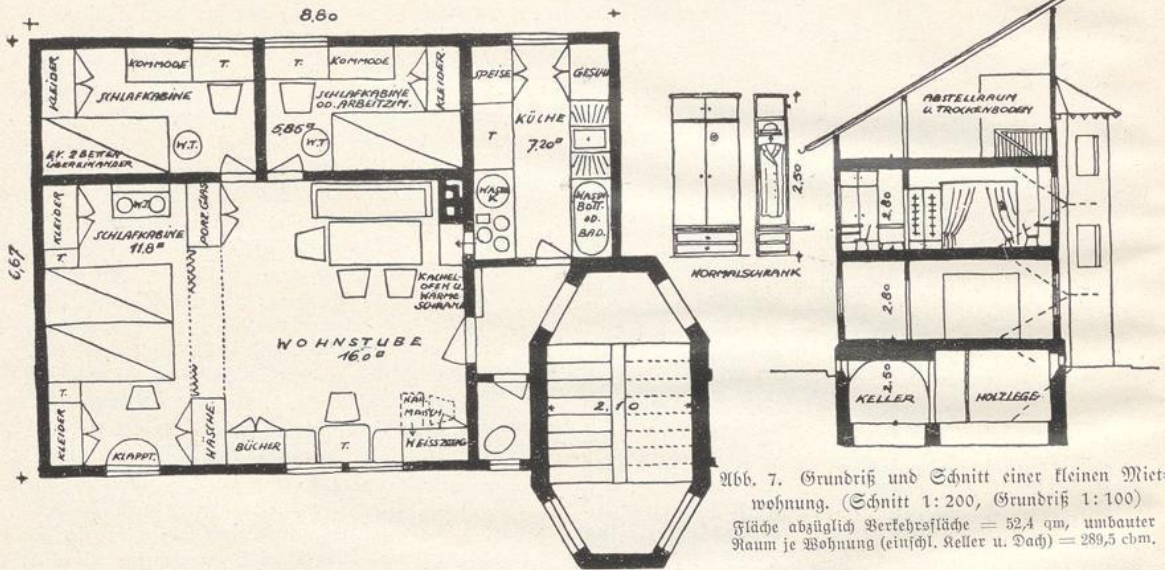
Grundriß und Schnitt einer kleinen Mietwohnung. (Schnitt 1:200, Grundriß 1:100)
